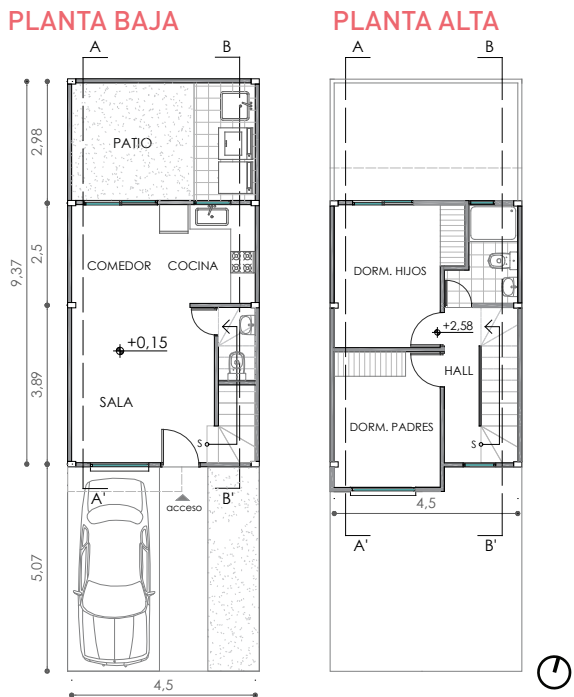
Plantas arquitectónicas vivienda esquinera noroeste
